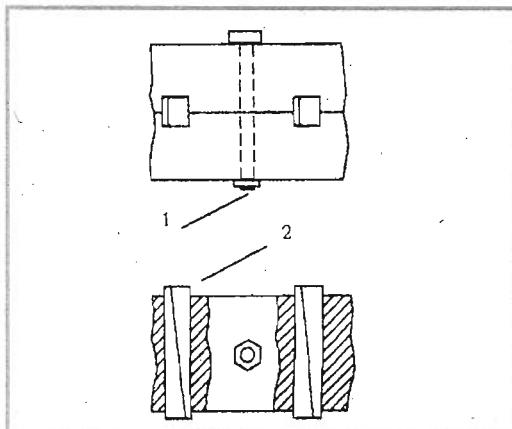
Нагельное соединение: 1 – стяжной болт; 2 – нагель
